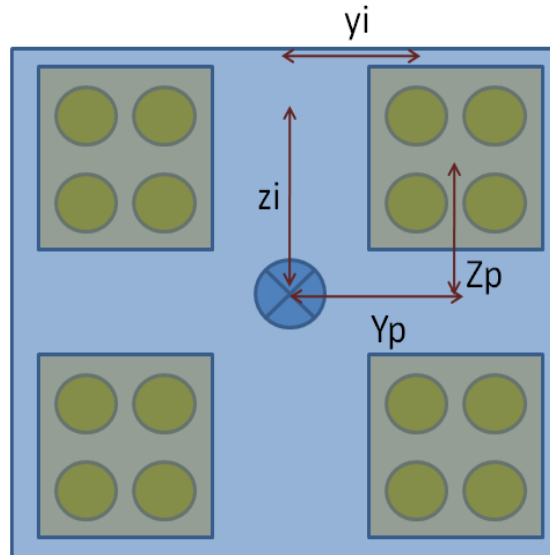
a : Exemple d'une section multipoutre constituée de 4 sous-poutres décrites par une section rectangulaire. Dans l'exemple les sous-poutres sont constituées de 4 fibres.
